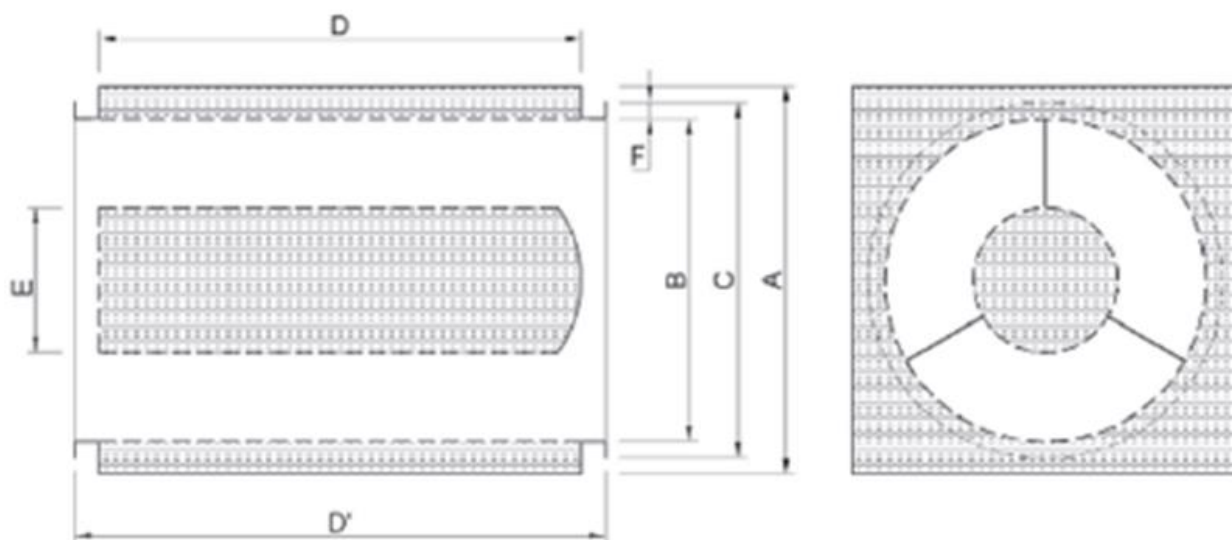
Глушитель с цилиндрической вставкой и прямоугольной формой наружного корпуса серии CAF-S фирмы Caryaire Equipments.
